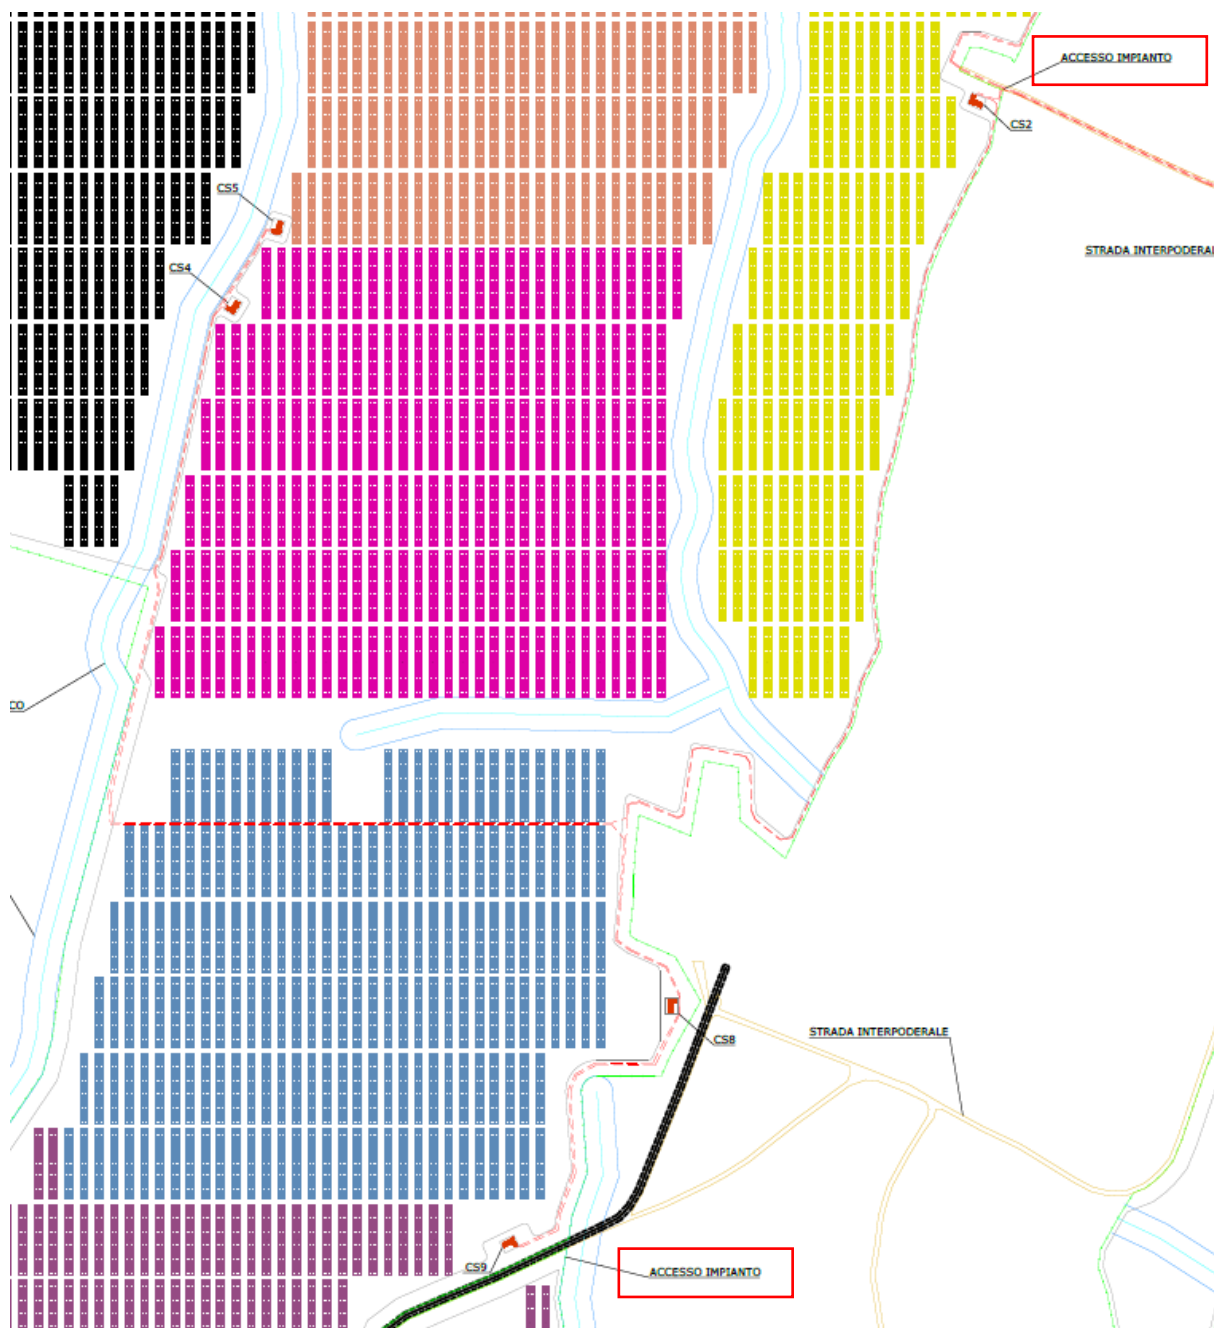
Vista della viabilità esistente Località Imposto Vaccareccia con accessi impianto.
